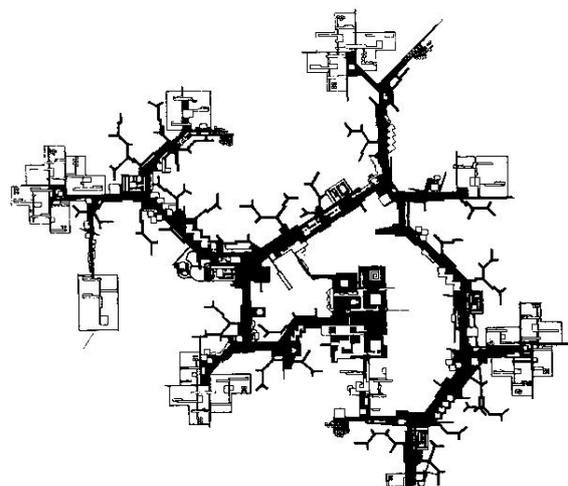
Plano de Toulouse-le-Mirail – esquema de circulação.
